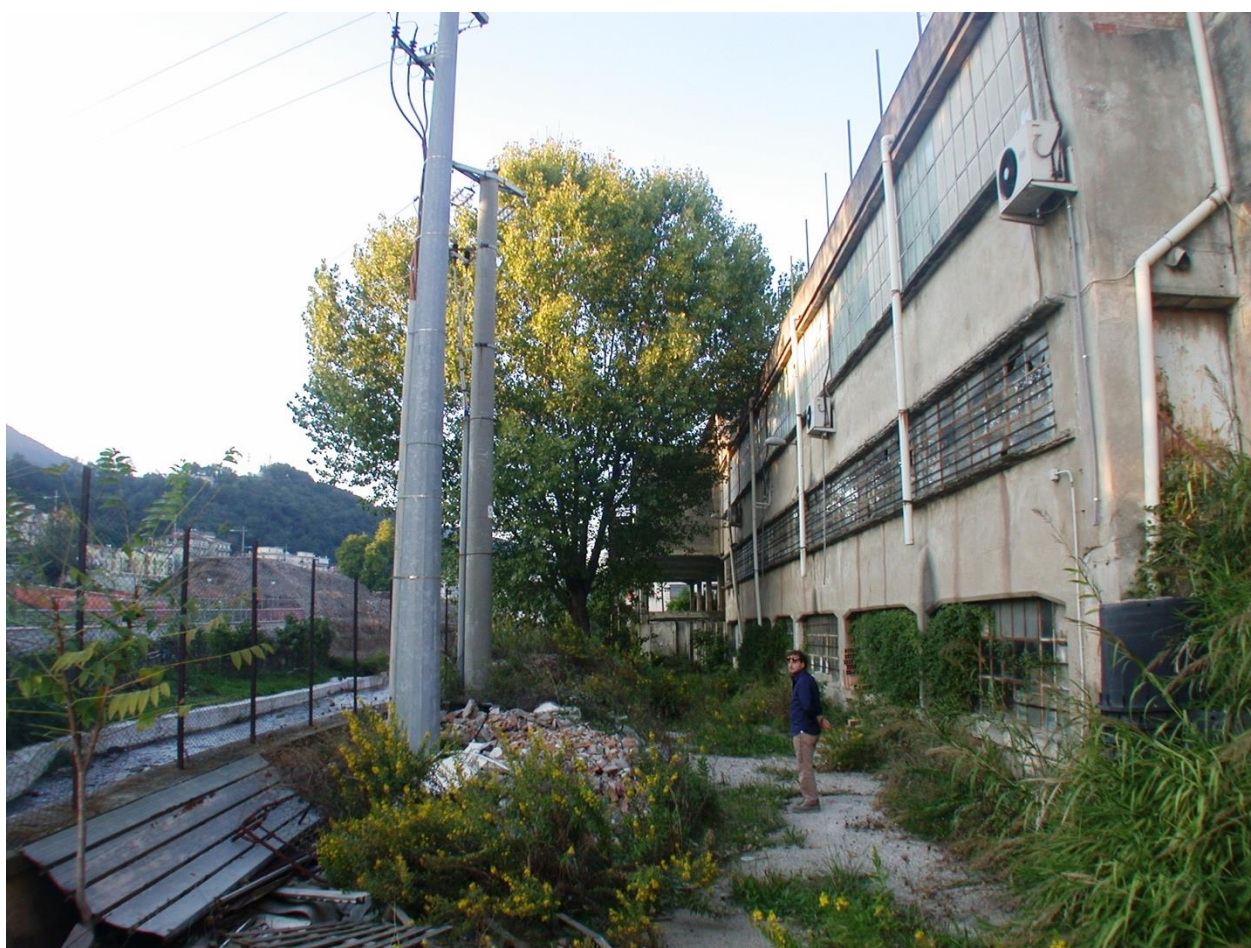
Vista della parte retrostante dell'edificio esistente
